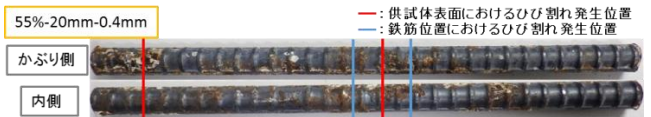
鉄筋腐食の様子とひび割れ発生位置の例
